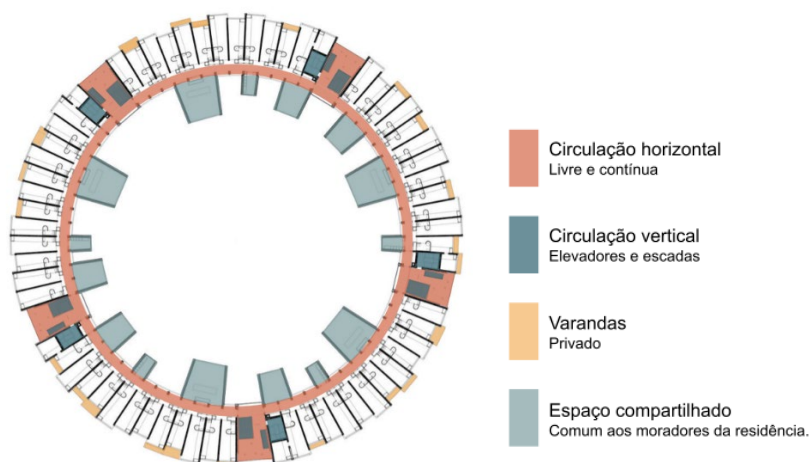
Planta térrea, demarcação de acessos e espaços coletivos.
